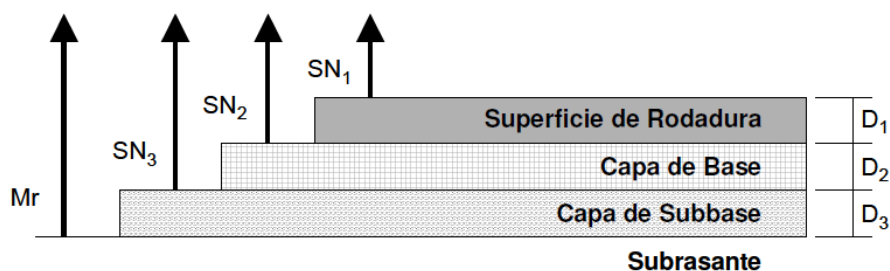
Representacion del numero estructural (SN) y espesores (D) de la estructura él un pavimento.
